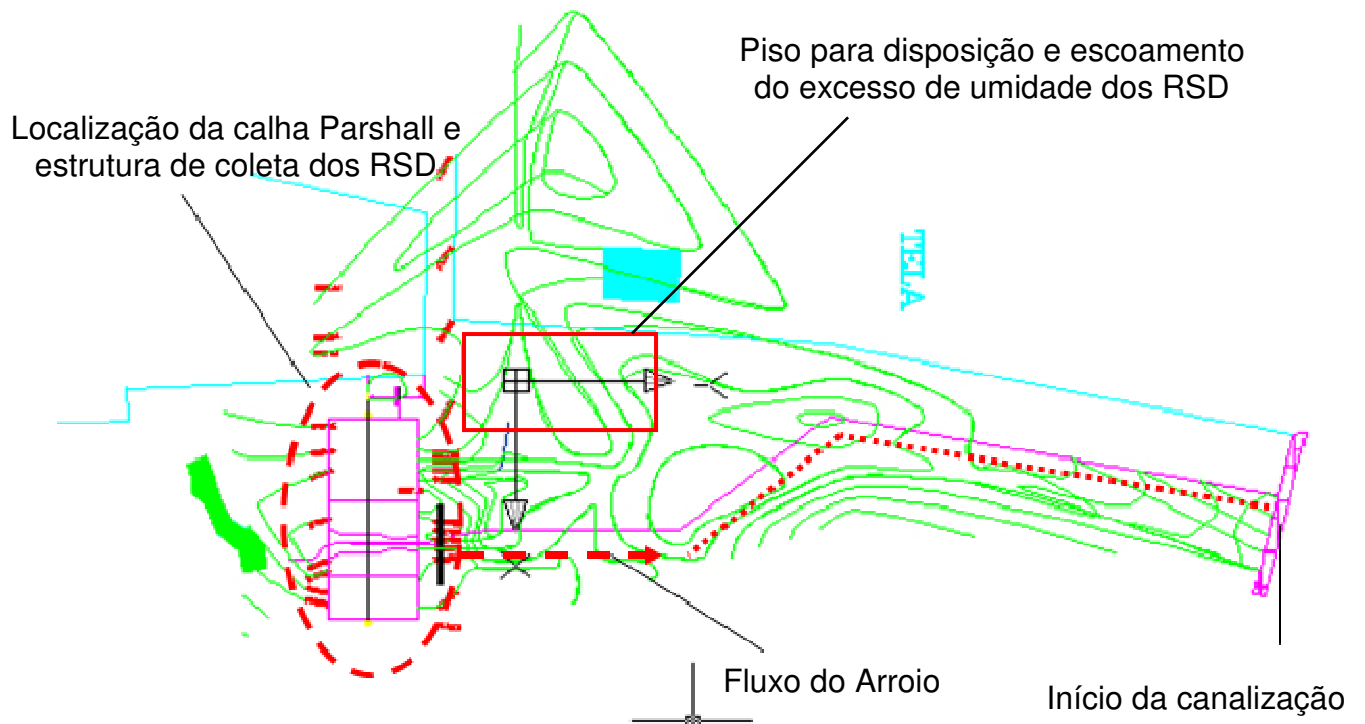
Croquis de localização da calha Parshall, estrutura de coleta dos RSD e fluxo do arroio.
